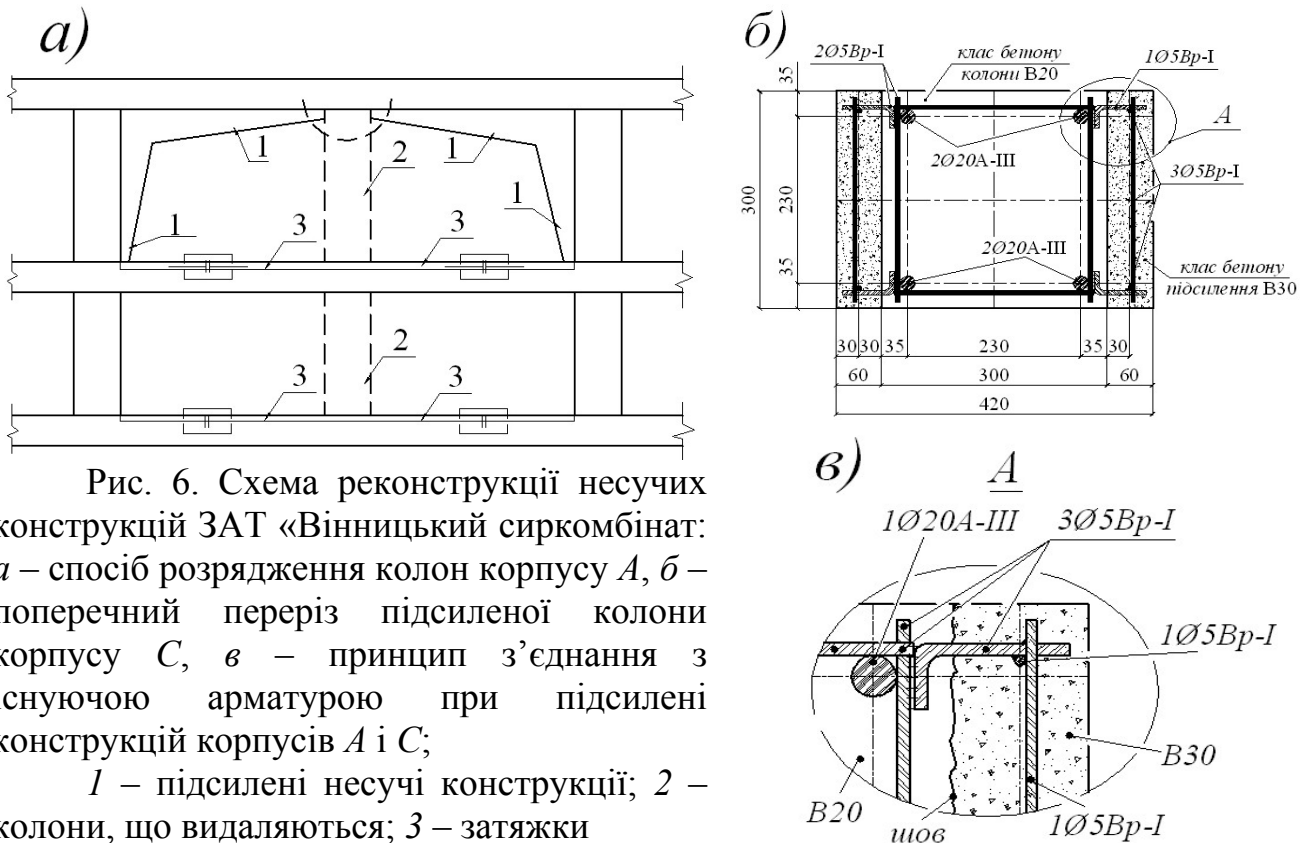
Схема реконструкції несучих конструкцій ЗАТ «Вінницький сиркомбінат»: а – спосіб розрядження колон корпусу А, б – поперечний переріз підсиленої колони корпусу С, в – принцип з'єднання з існуючою арматурою при підсиленні конструкцій корпусів А і С;
